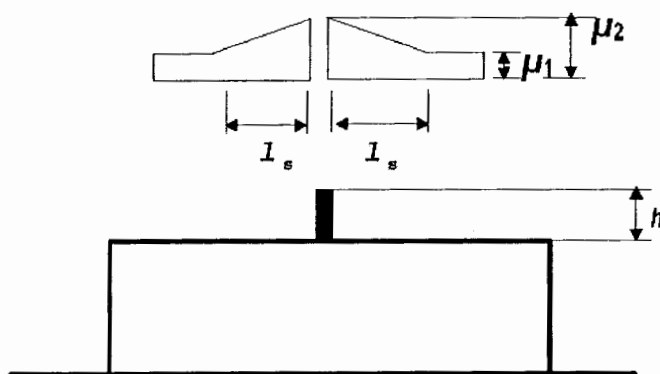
Coefficienti di forma in prossimità di parapetti e pareti verticali
